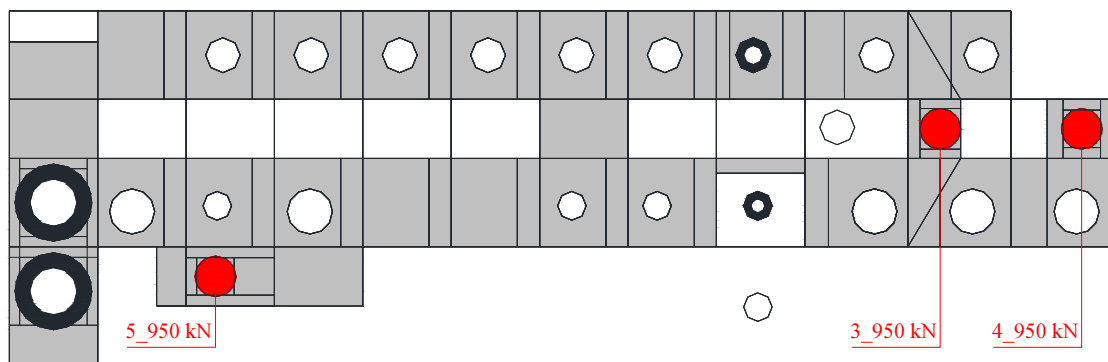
Pianta 7° piano, quota + 36.50 m
